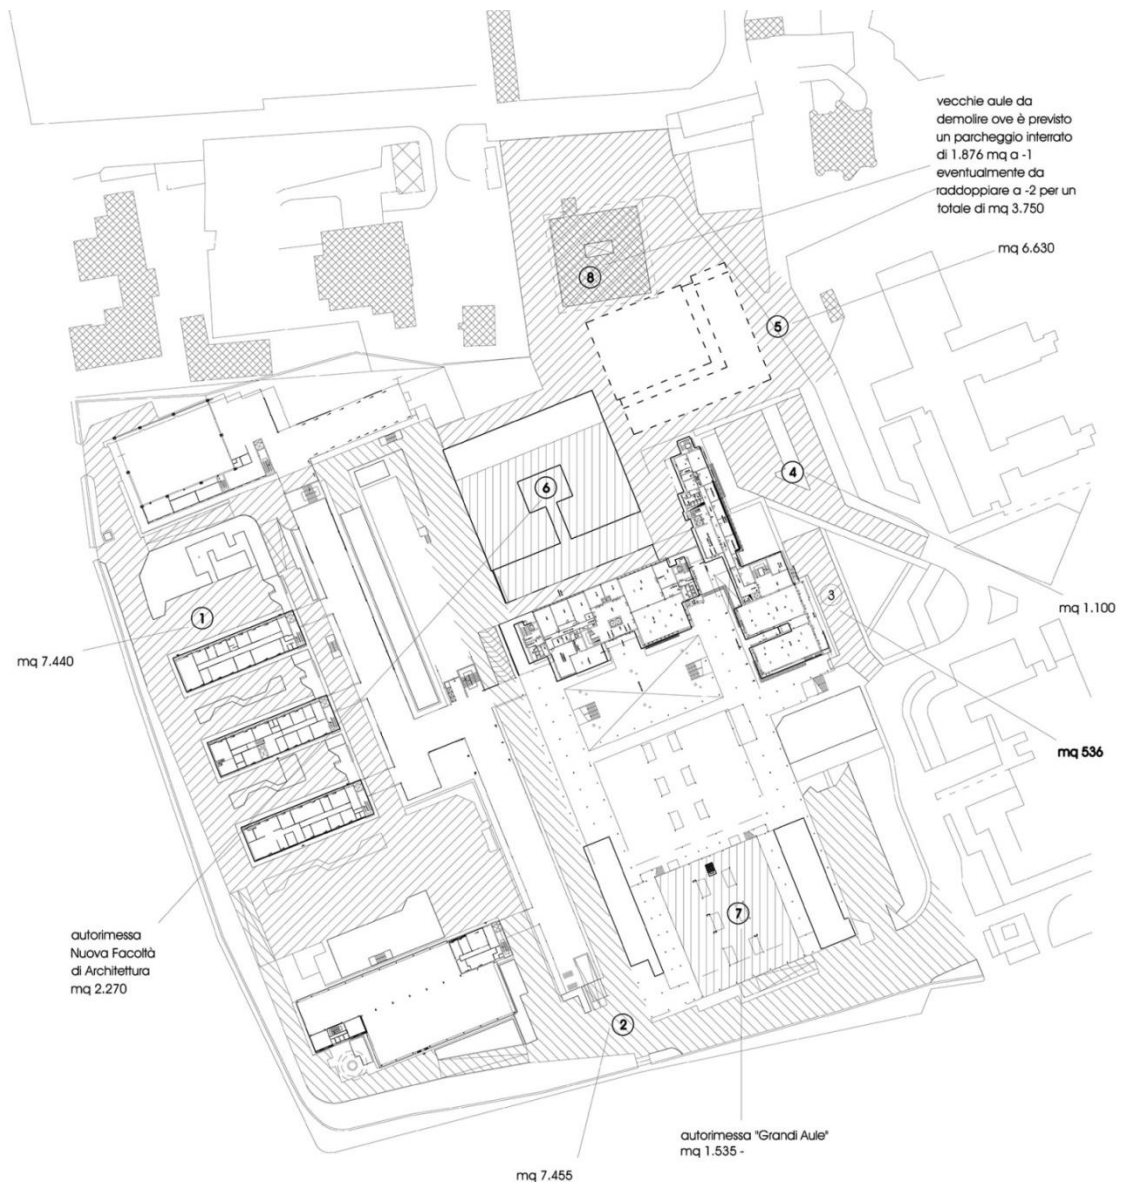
Planimetria con l'indicazione delle aree destinate a parcheggio nel Campus Universitario
